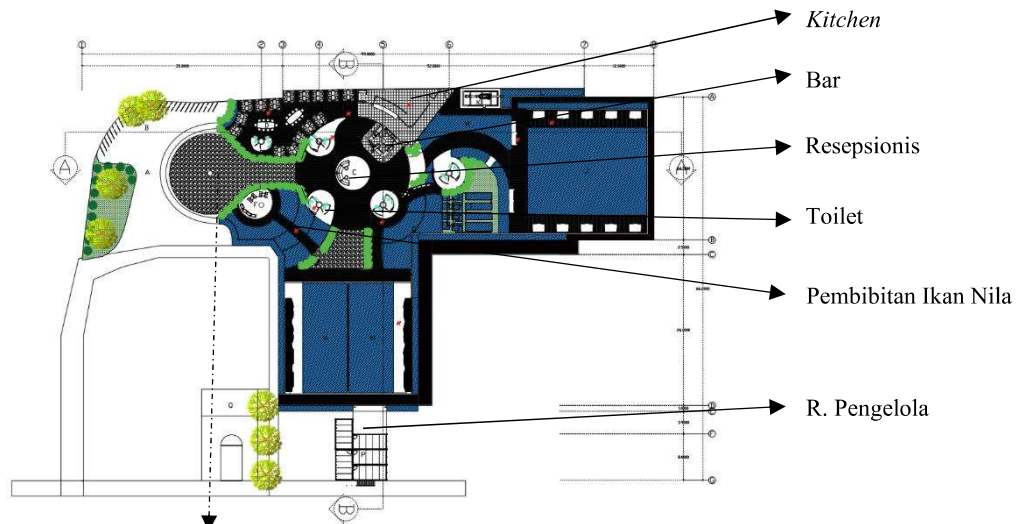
Rencana Site Plan Pusat Pemancingan dan Rekreasi Sekeloa Timur
